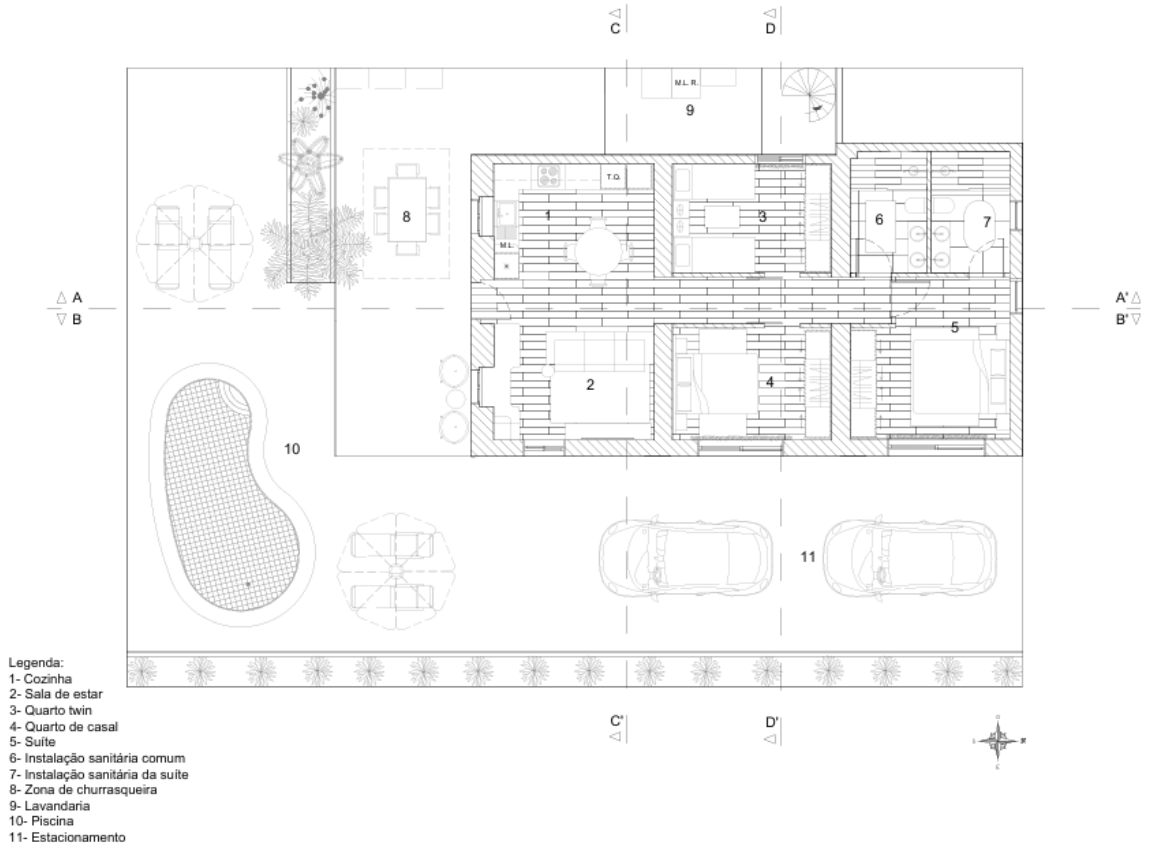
Planta de apresentação (Fonte: Rita Giro, 2025)
